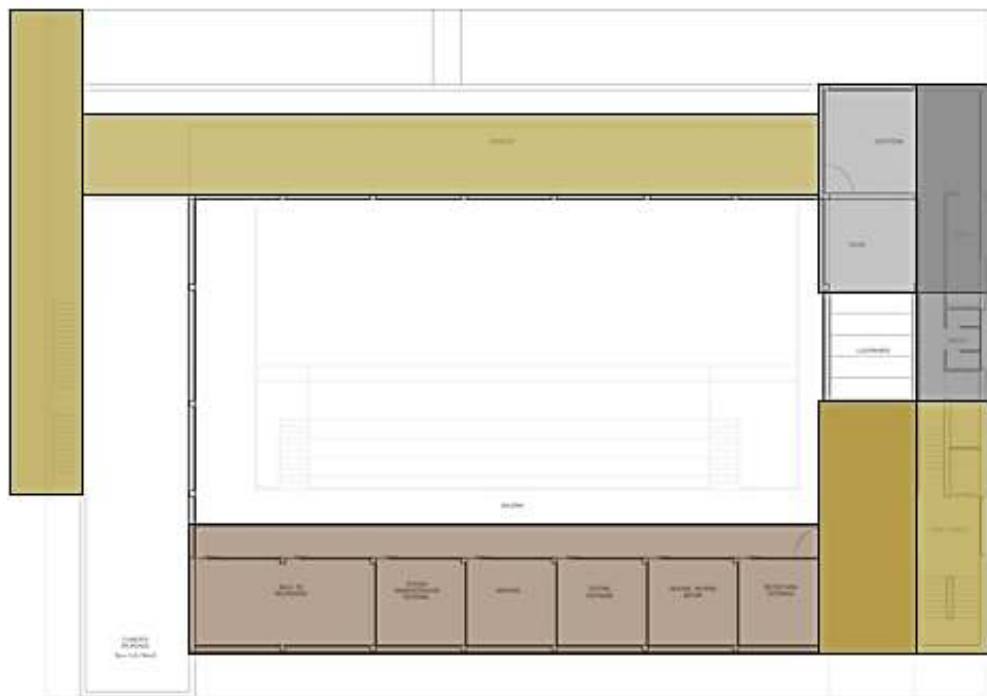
Planta General Puerto Pesquero y Deportivo
